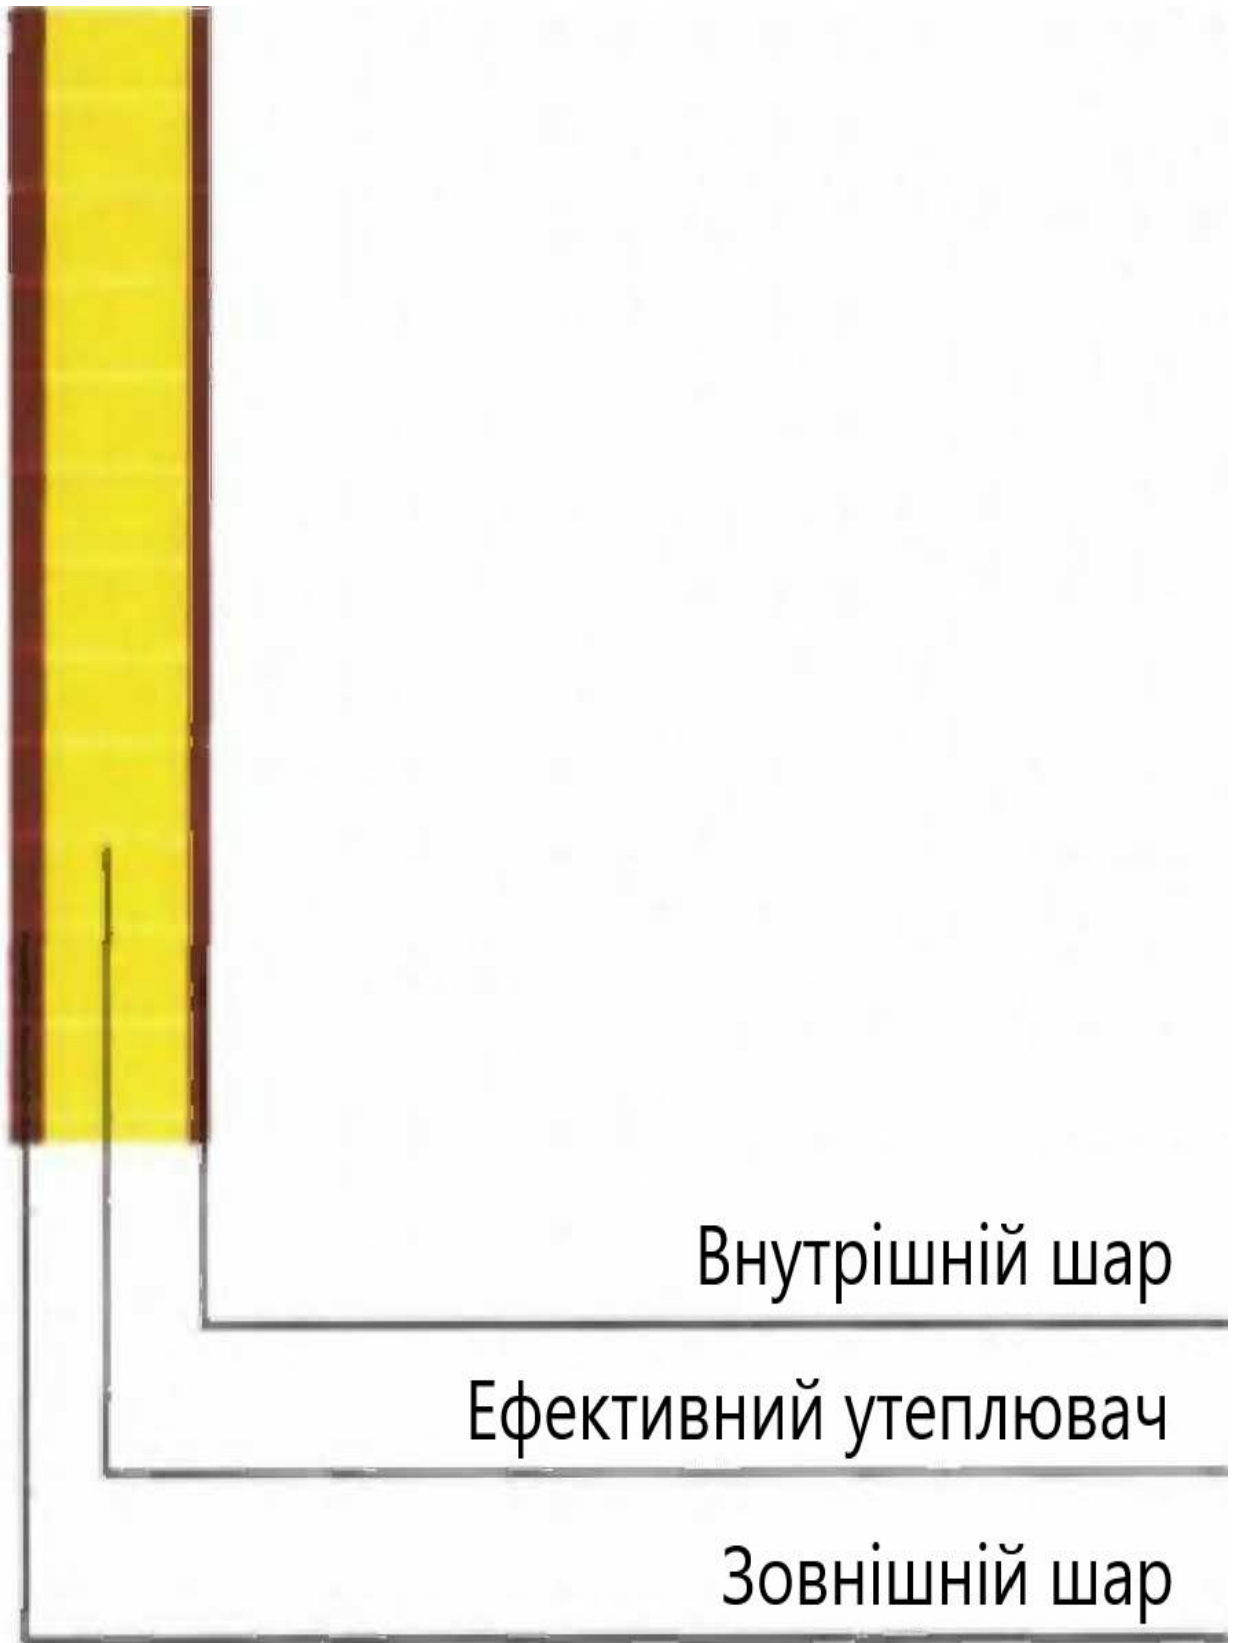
Схема тришарової панелі з шаром профільованого металевих листа і ефективним утеплювачем бетону
